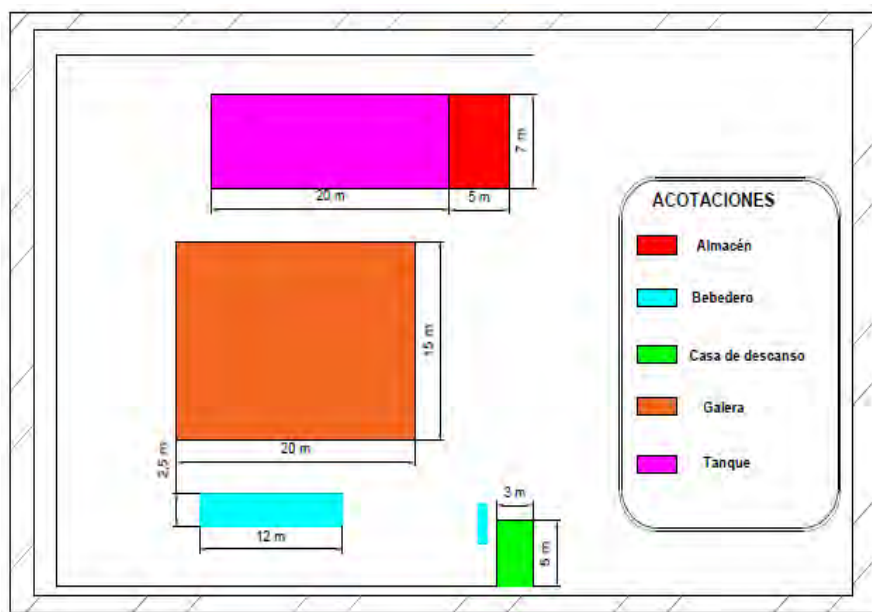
Distribución de la planta de la empresa Granja Ejega.
